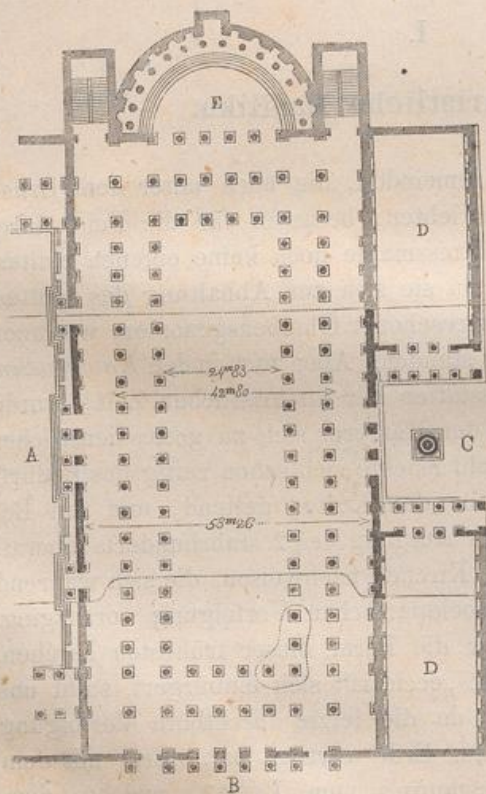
Grundriss der Basilika Ulpia.
